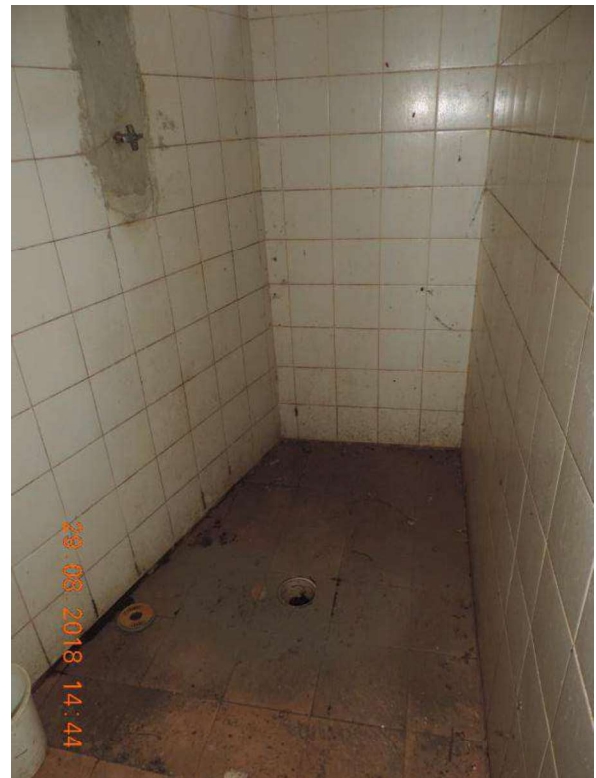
VISTA INTERNA DA “CASA DO CASEIRO”
